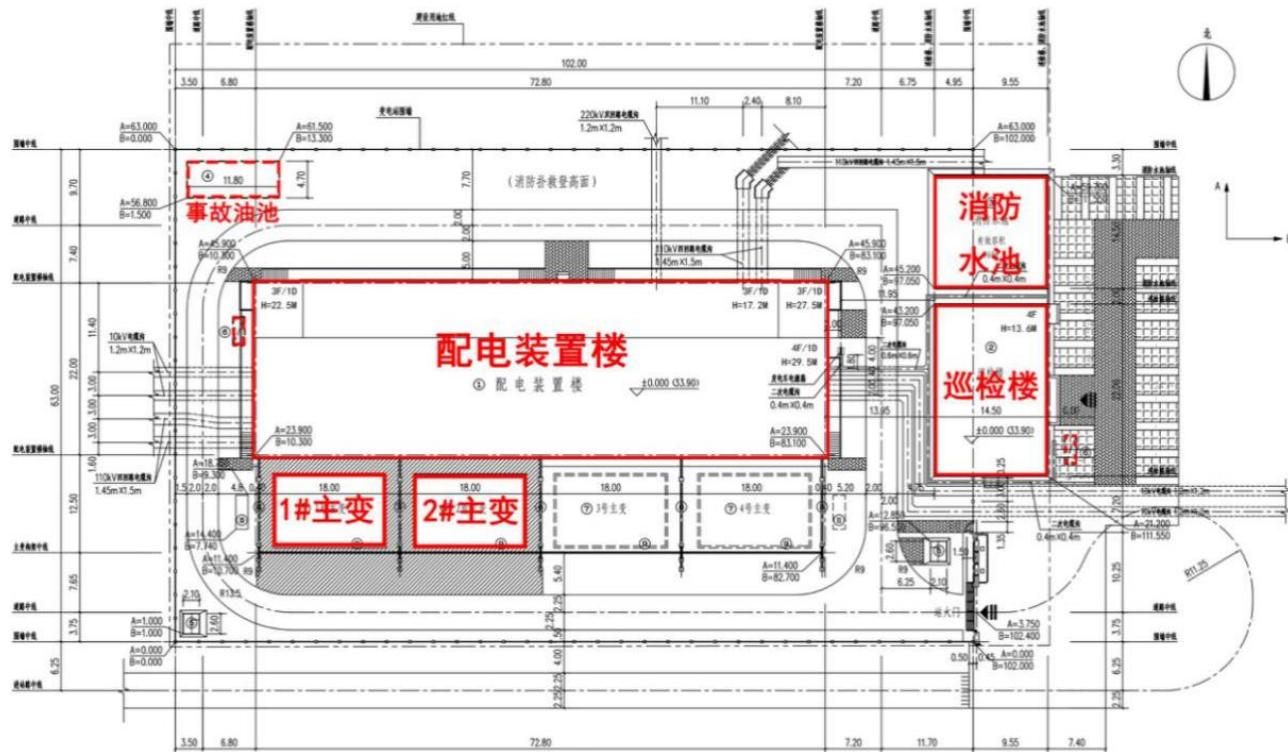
茂名 220 千伏宴镜（茂港）变电站总平面布置示意图
